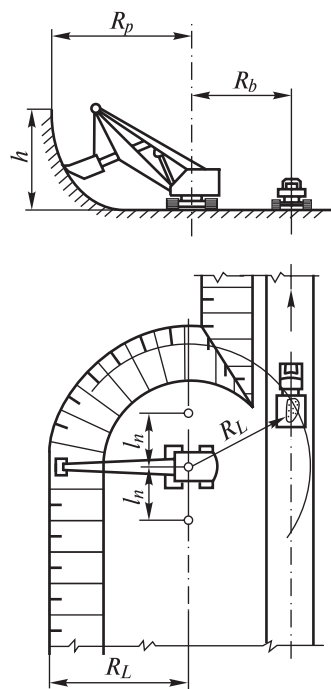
Схема забоя при устройстве котлована боковой проходкой экскаватором, оборудованным прямой лопатой
